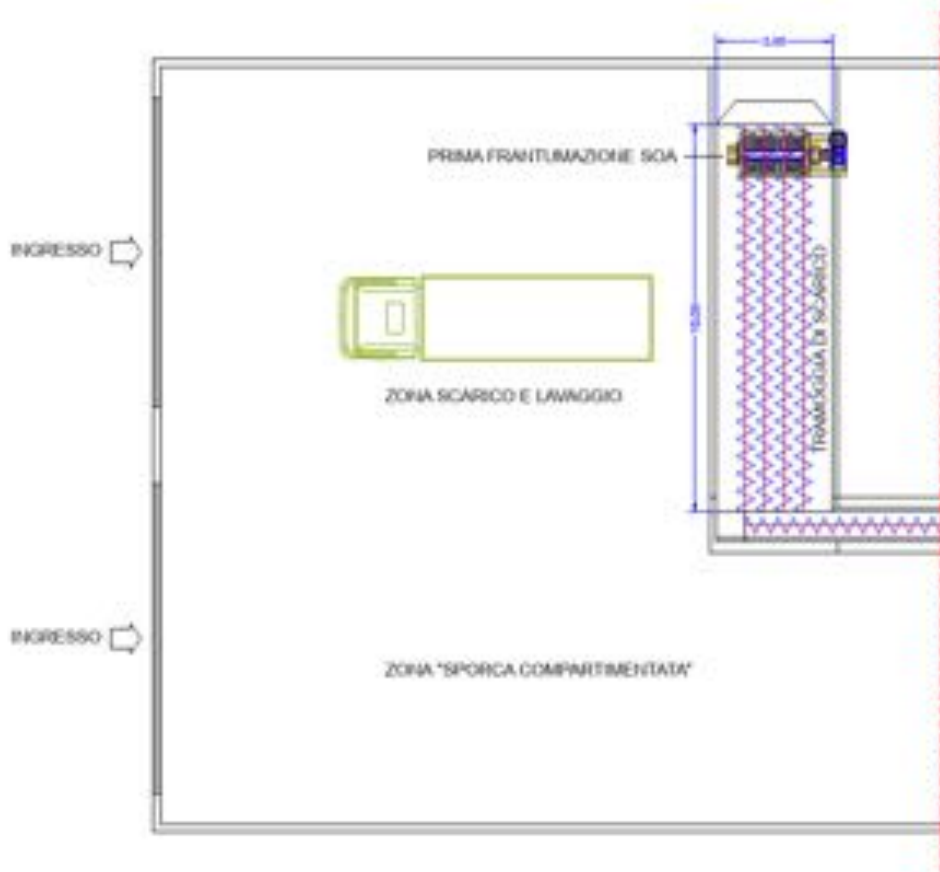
planimetria della zona "sporca" dell'impianto. Tramoggia di scarico.
